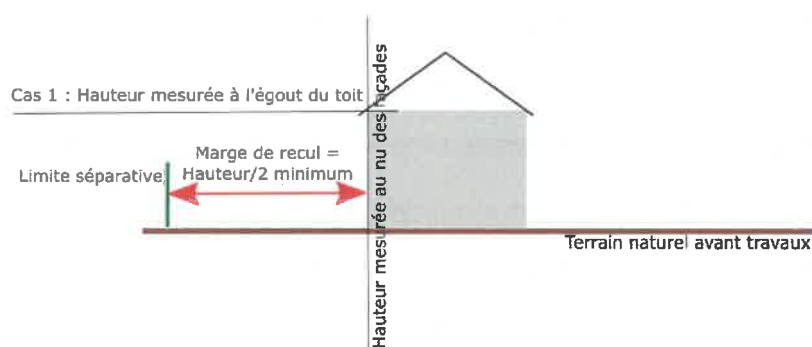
Règle d'implantation par rapport à la limite séparative - égout du toit
